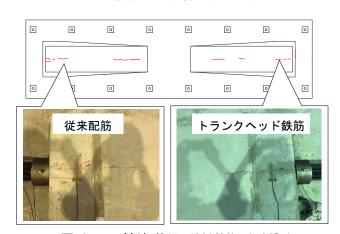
ひび割れ状況 (3000kN:0.96Pu)
